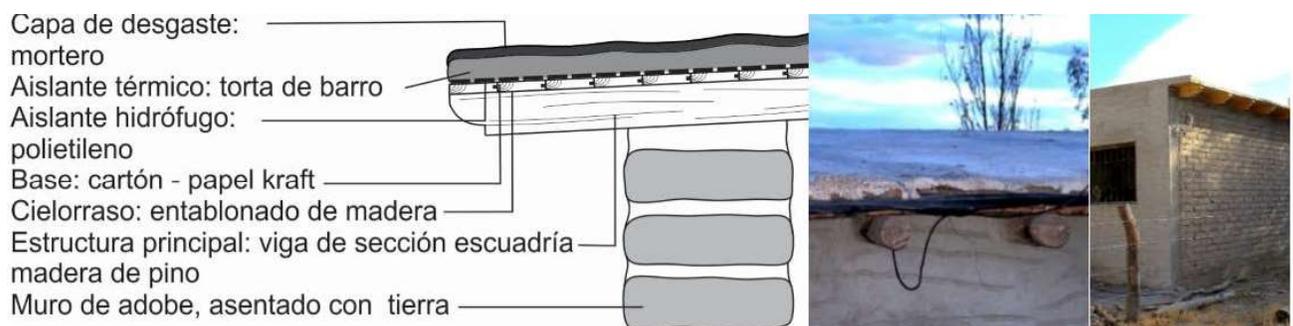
Vivienda en Los Zazos y en Colalao del Valle
